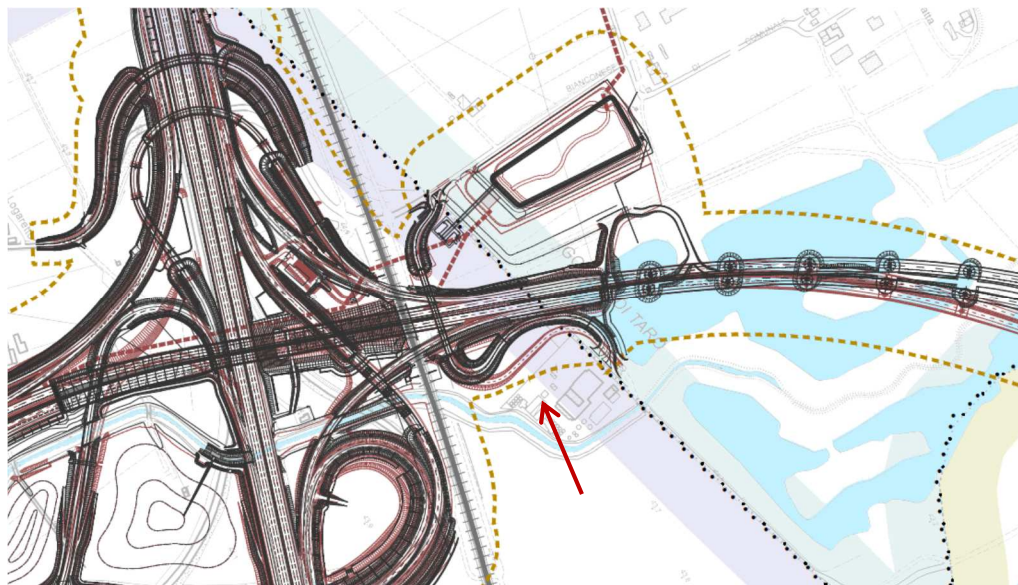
Cavalcavia Synthesis - raffronto fra configurazione prevista in PE (in nero) e configurazione prevista nel Progetto Definitivo (in amaranto)
